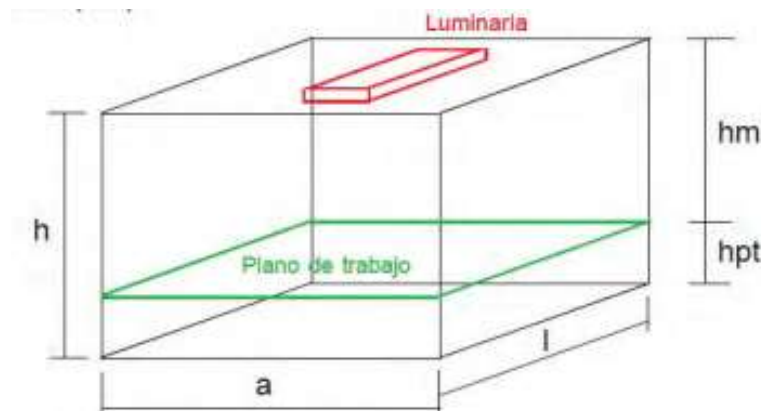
18 Altura de iluminaria y plano de trabajo.
